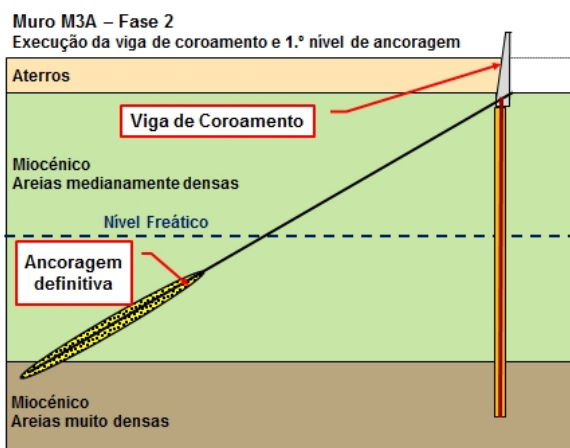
Fase 2 do faseamento construtivo do Muro M3A.
